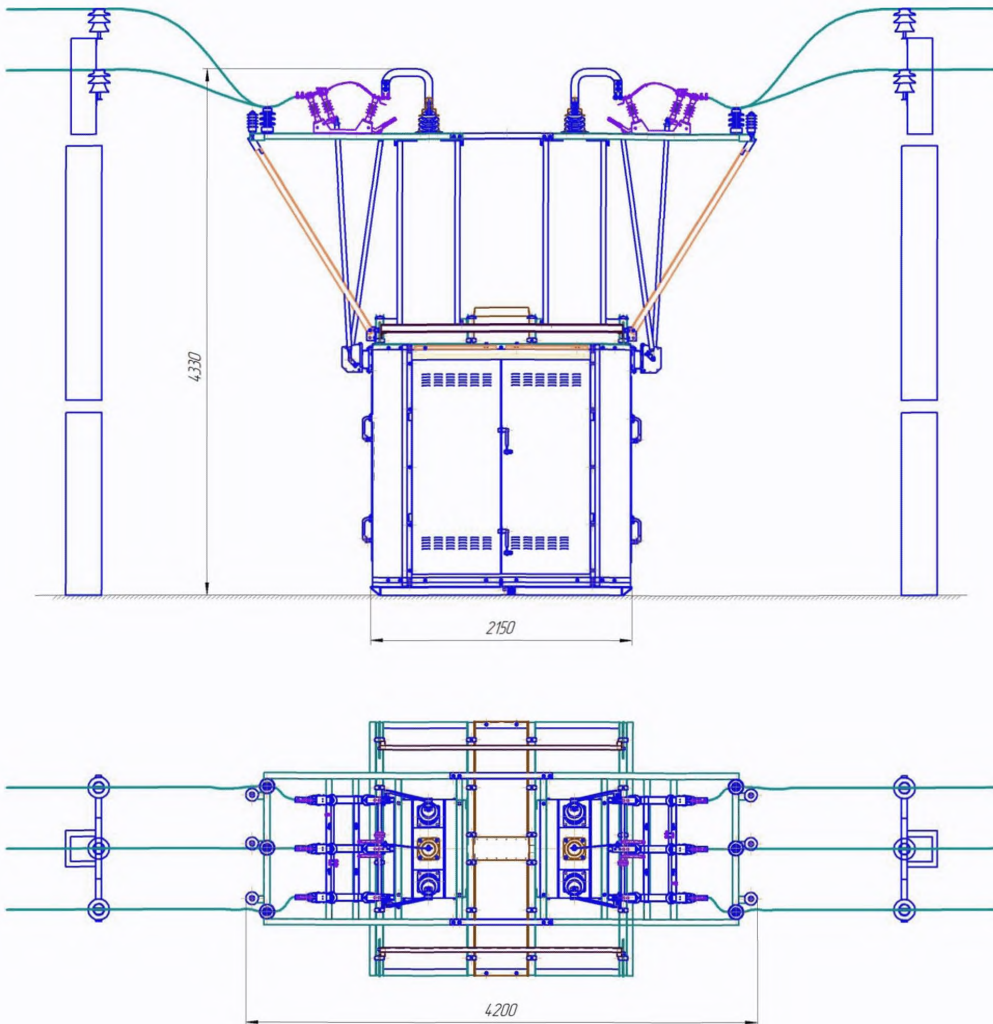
Габаритные размеры ПС-СЭЩ
